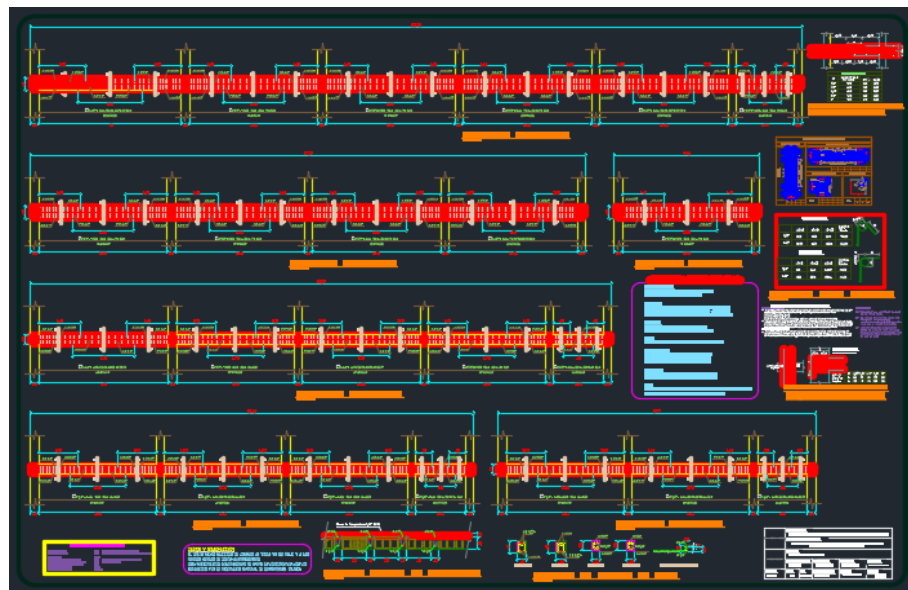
E-03: VIGAS Y DETALLES.
